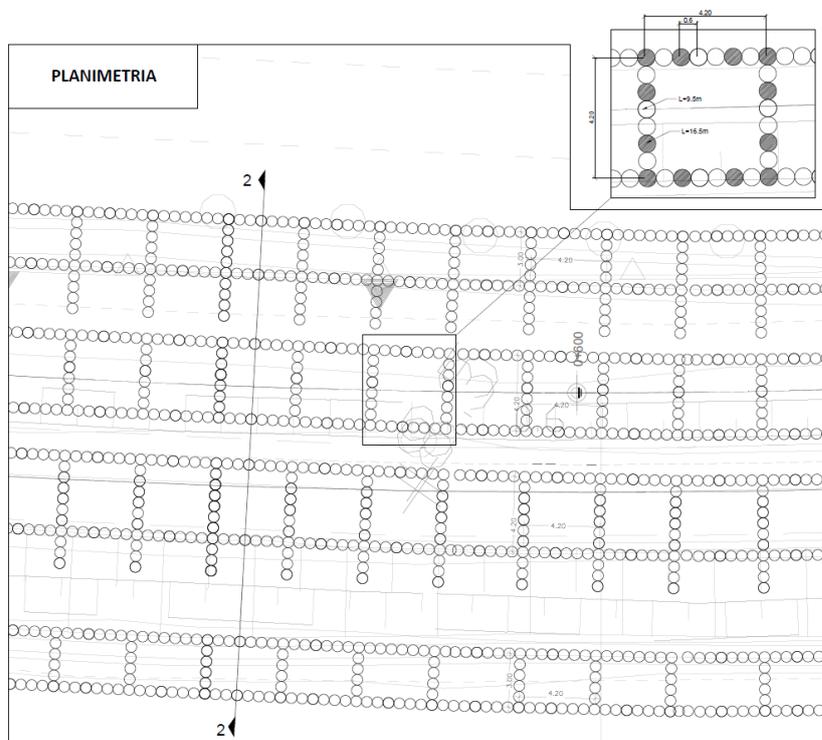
Sezione rappresentativa tratta 0+600 – 0+793 - planimetria
